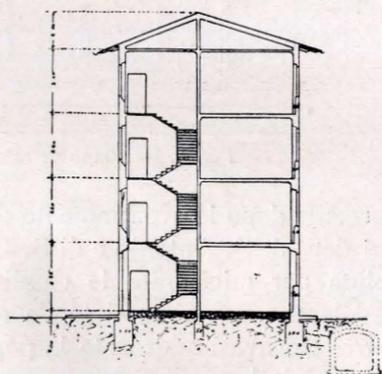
Sezione trasversale dell'edificio B (scala 1:400).
